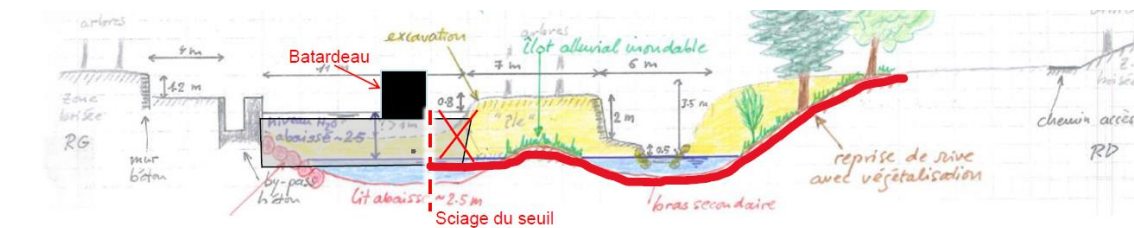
Étape 2 des travaux dans le secteur du seuil (construction de la rive droite) - profil-type
